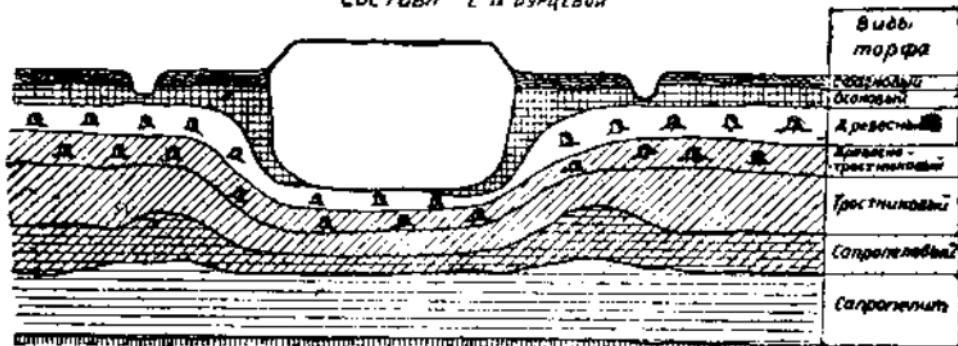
Поперечный разрез насыпи на болоте 8,5 м.
